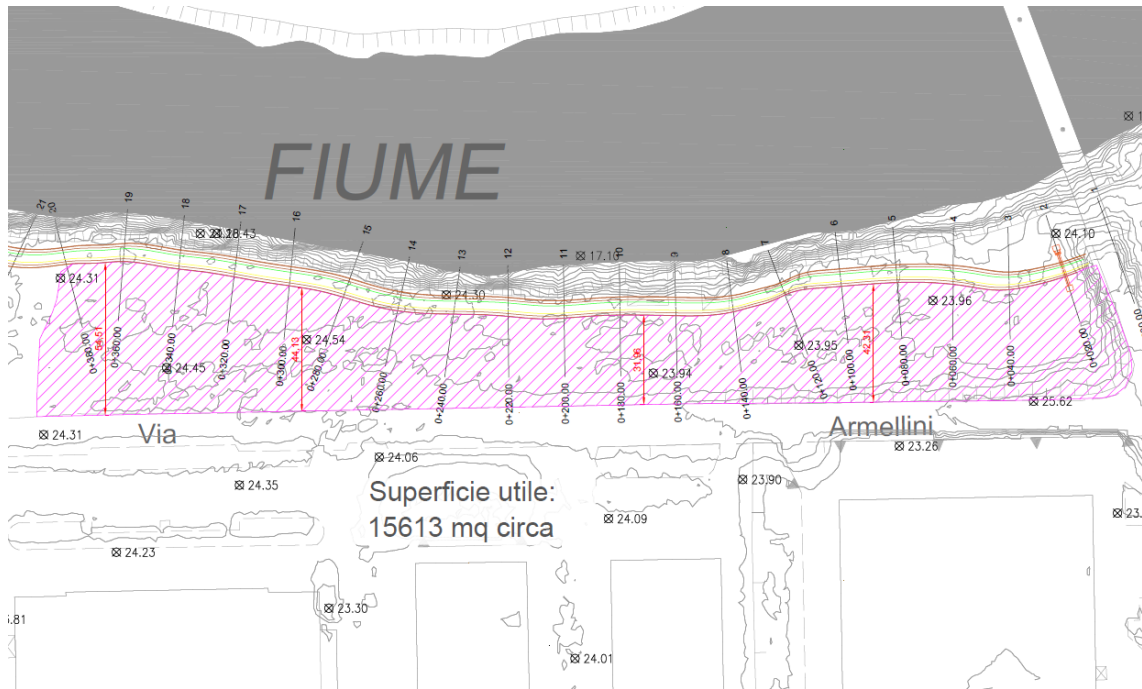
Stralcio della planimetria di progetto relativamente alla nuova (3°) ipotesi del tracciato arginale (Monterotondo Scalo).
